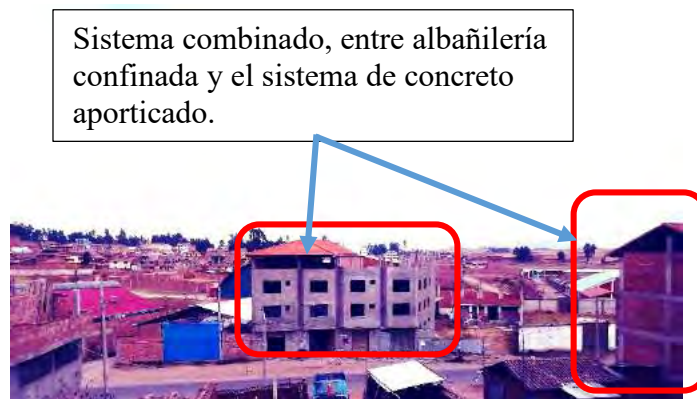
Viviendas de albañilería confinada y sistema aporticado. Fuente: Elaboración propia, 2019.
